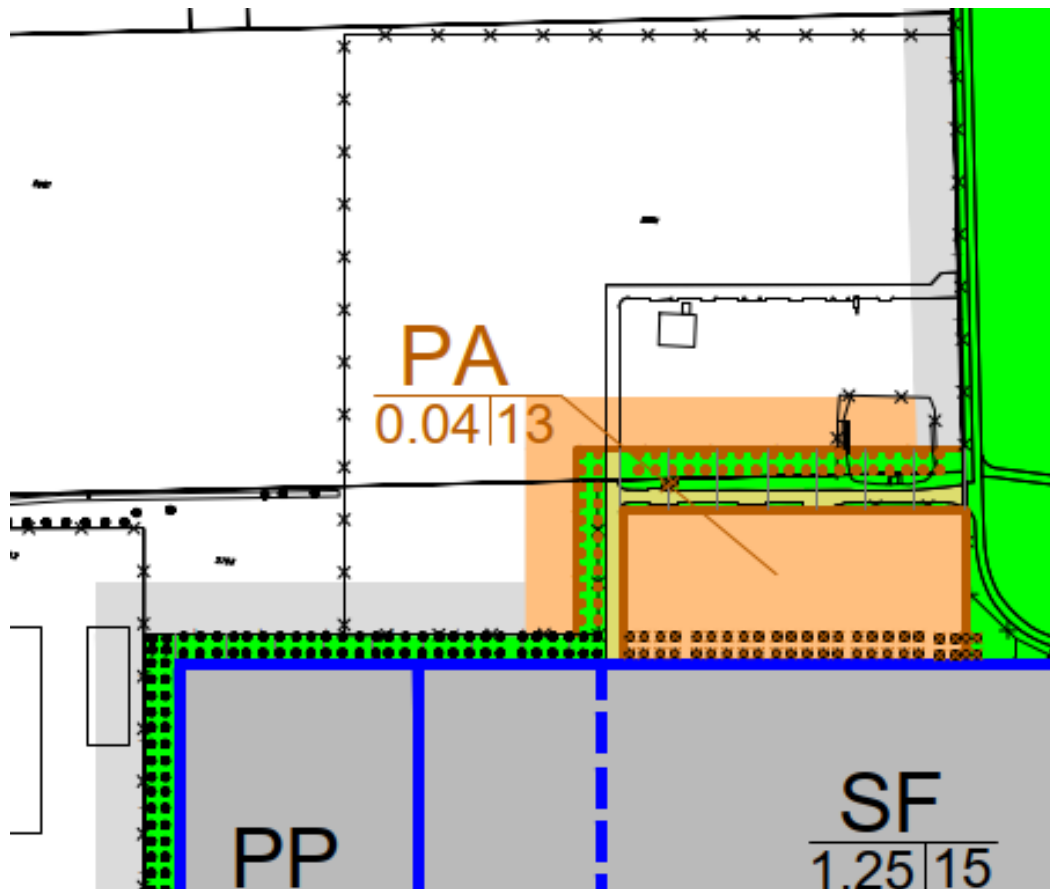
Auszug aus dem Plan der baulichen Anlagen (Tektur zu Plan I-02c).
